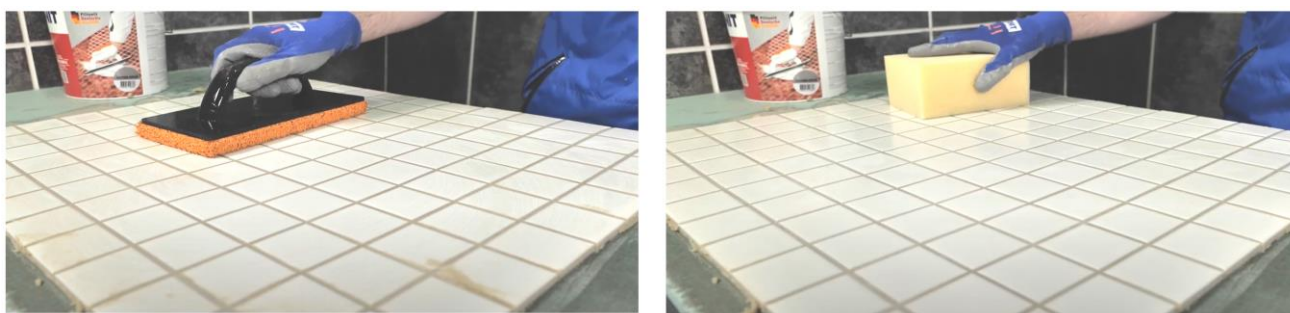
Диагональными движениями шпателя убрать с поверхности плитки излишки затирки
